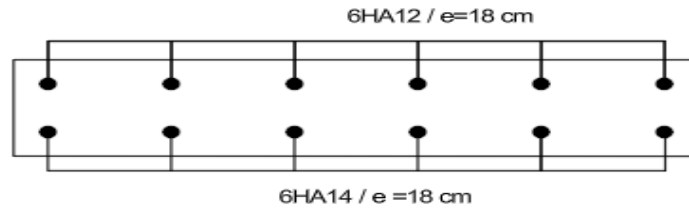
Schéma de ferrailage longitudinale de la dalle
